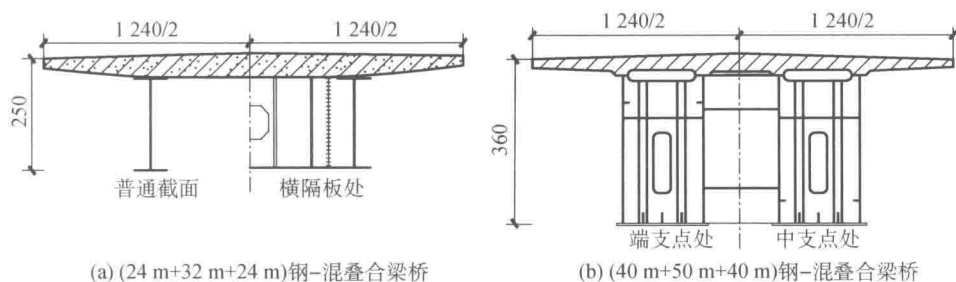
秦沈客运专线钢-混凝土叠合梁桥断面示意图(单位:cm)
